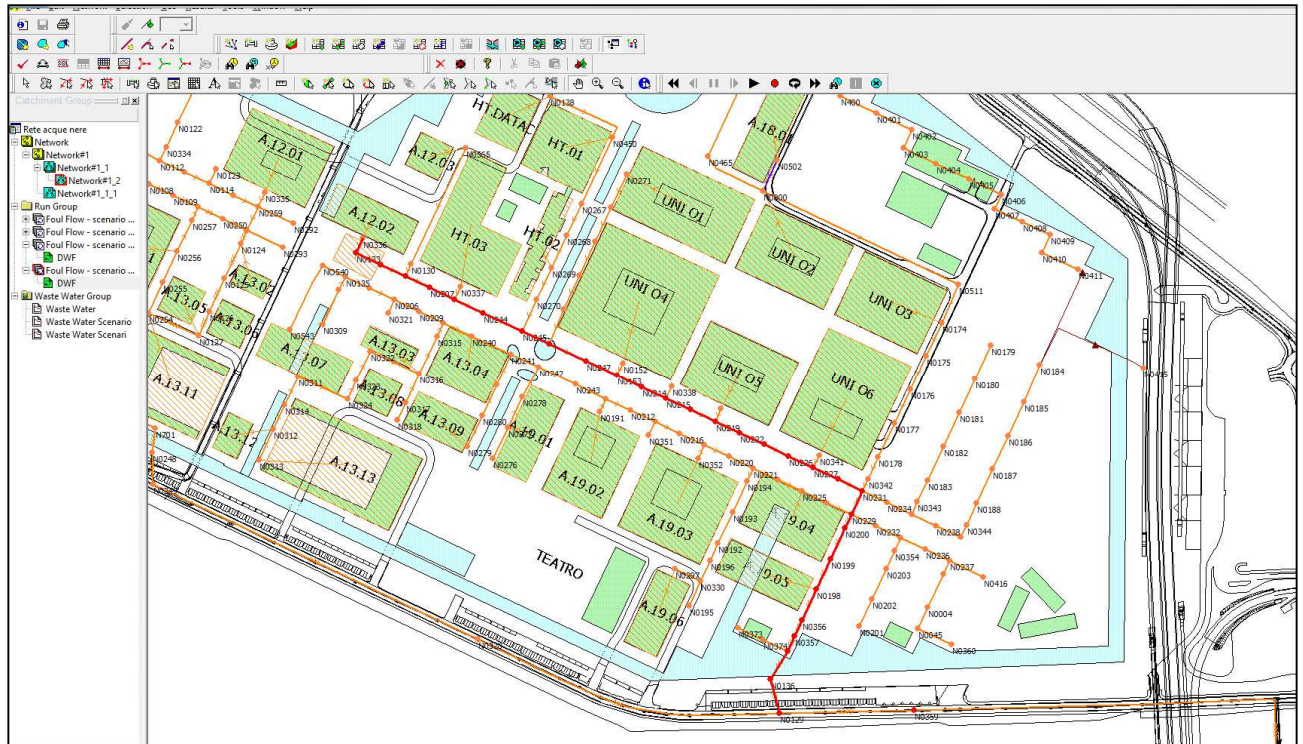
Stralcio planimetrico del tratto di profilo sopra riportato (in rosso i condotti selezionati)
